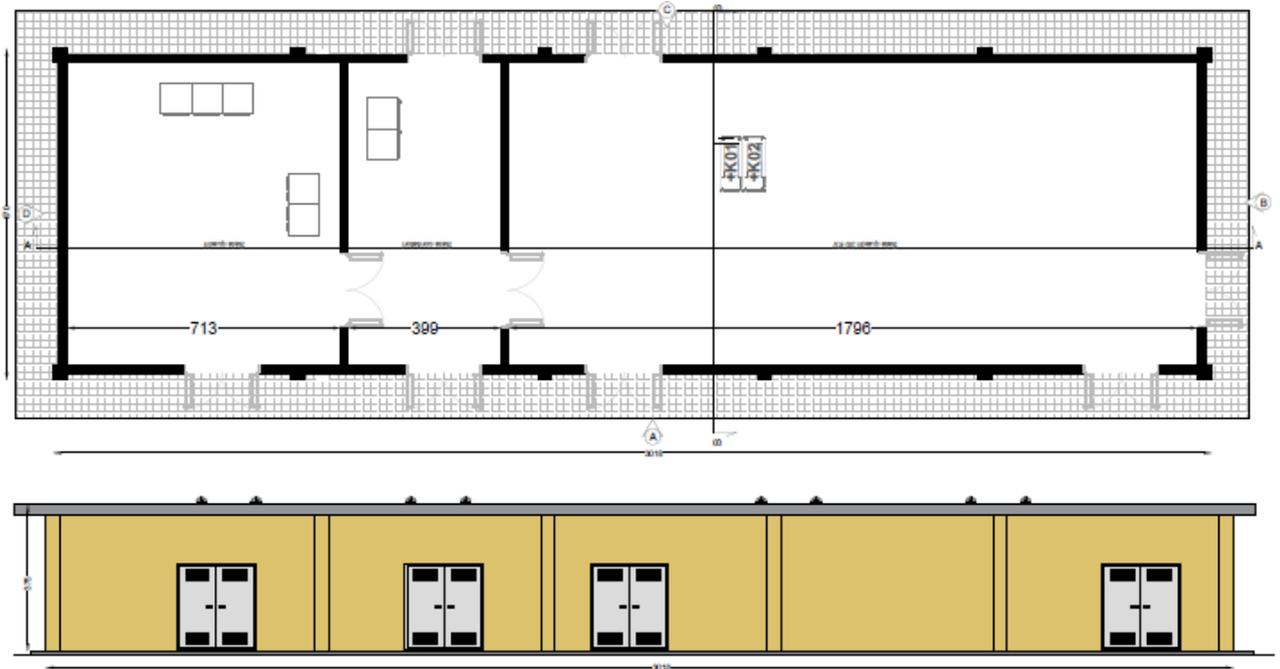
Pianta e prospetto tipo della cabina generale BESS
